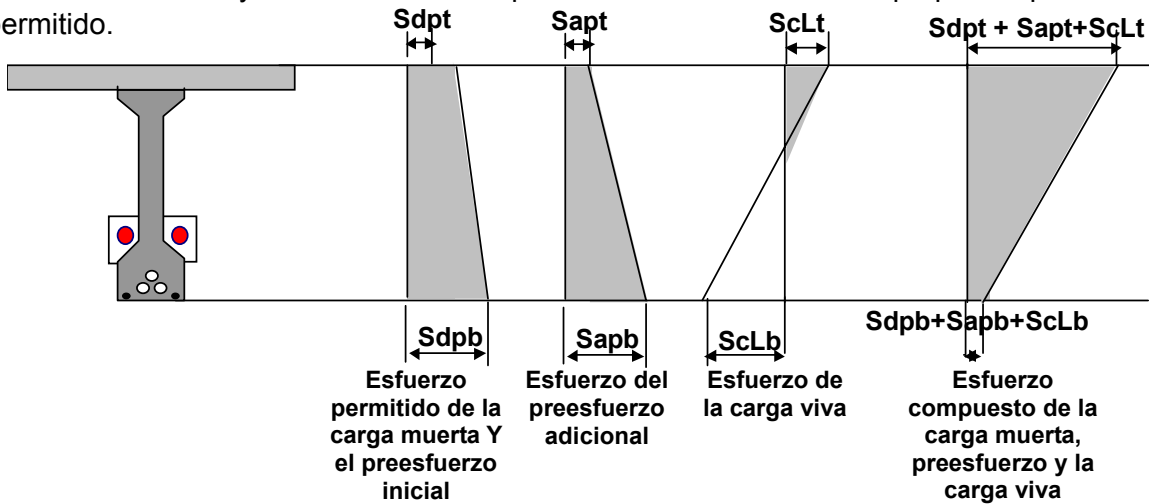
Esfuerzo para la viga tipo I prefabricada reforzada al añadir un cable externo
